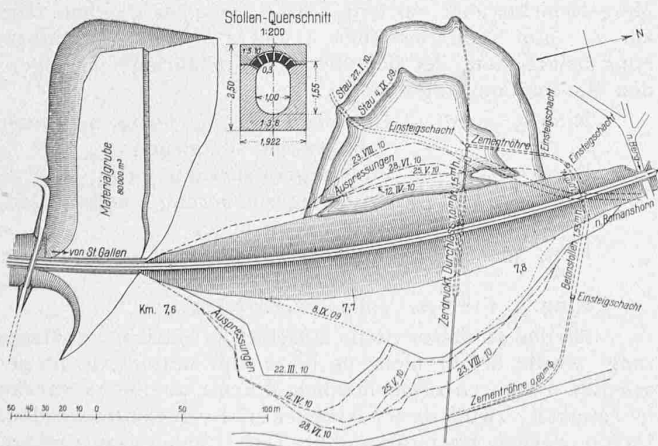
Lageplan mit Auspressungen und Stauee. — 1 : 4000.
